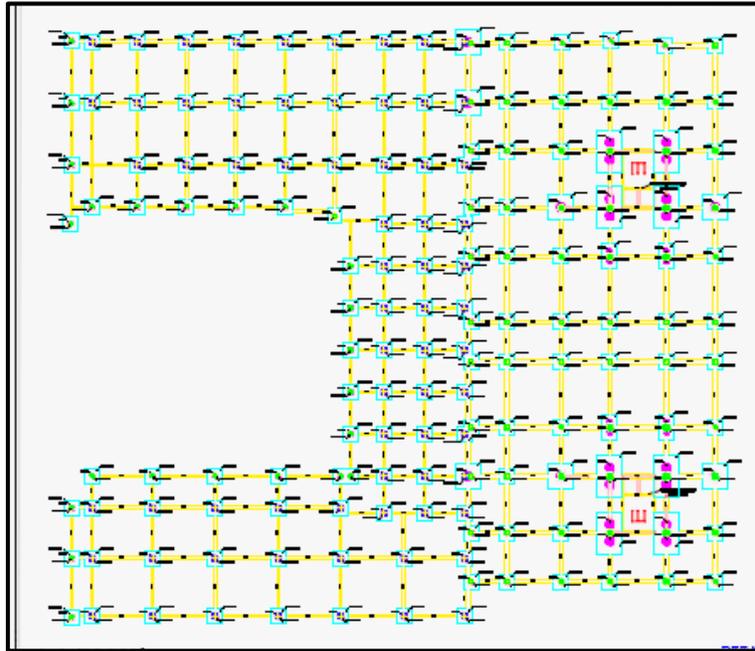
Pilas (cabezas) unidos a base de contra traveses, de concreto reforzado.
